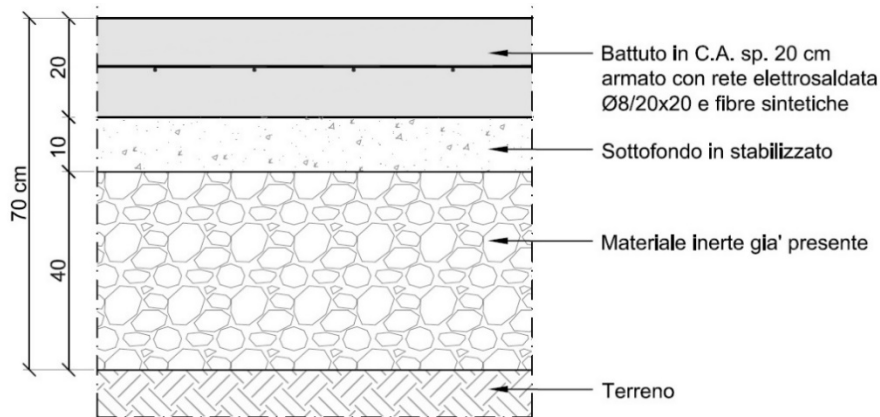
Pacchetto tipologico pavimentazioni in battuto di cemento
